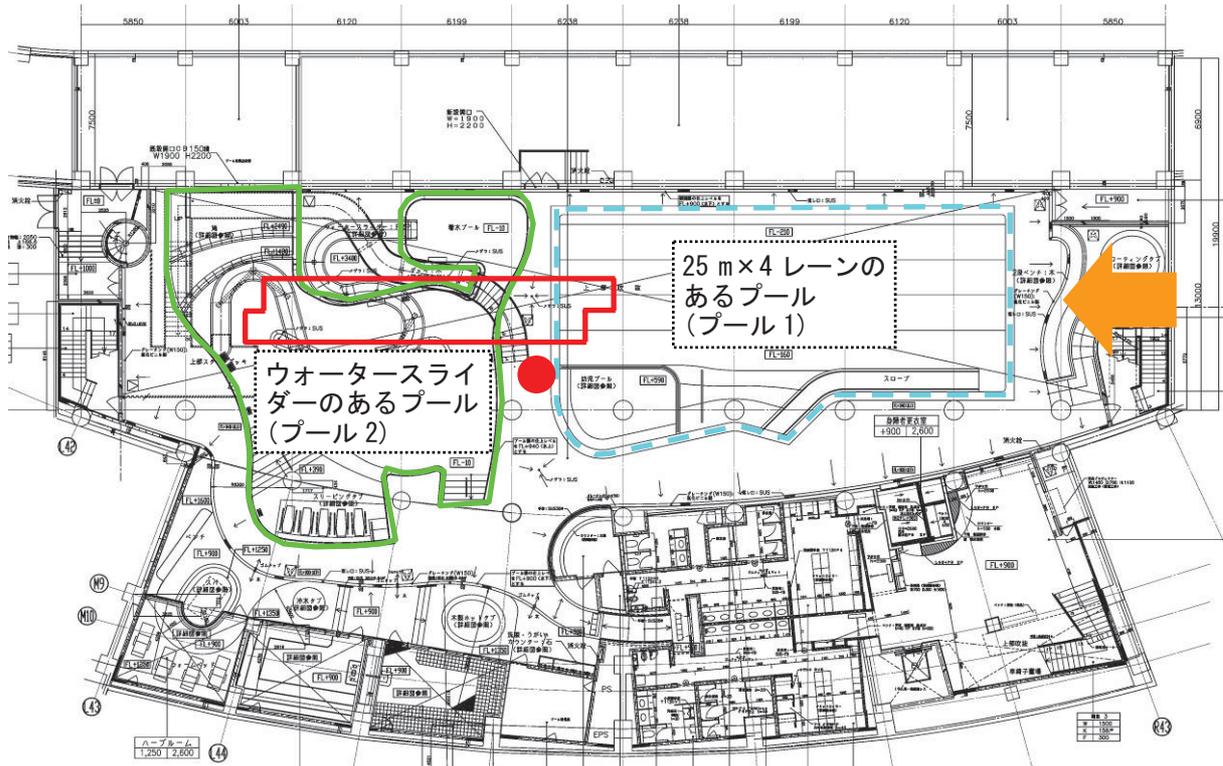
地下2階平面図 (赤枠内付近が天井板脱落箇所)
